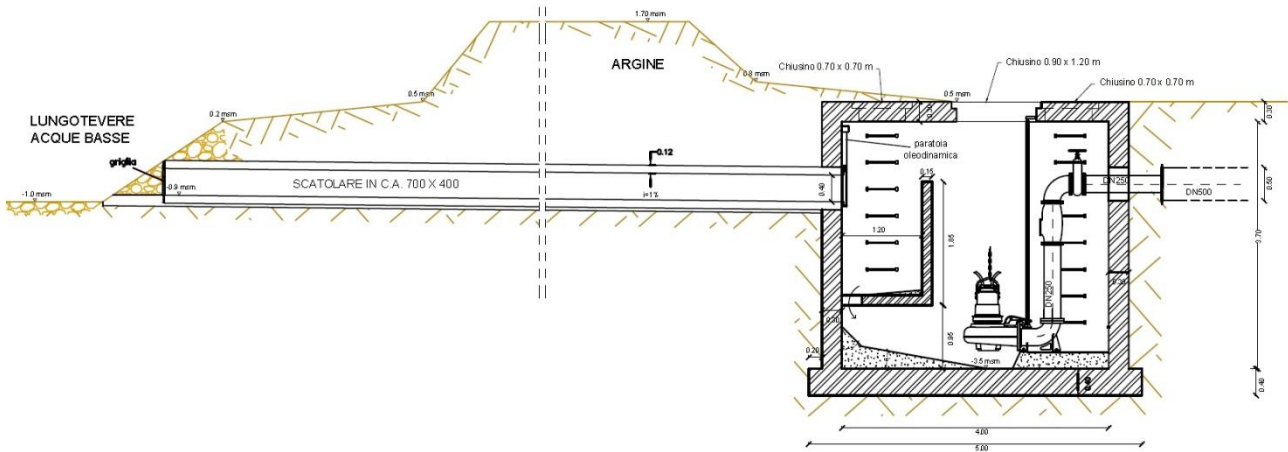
Stazione di sollevamento ‘Passo della Sentinella’: sezione longitudinale del pozzetto di carico.
